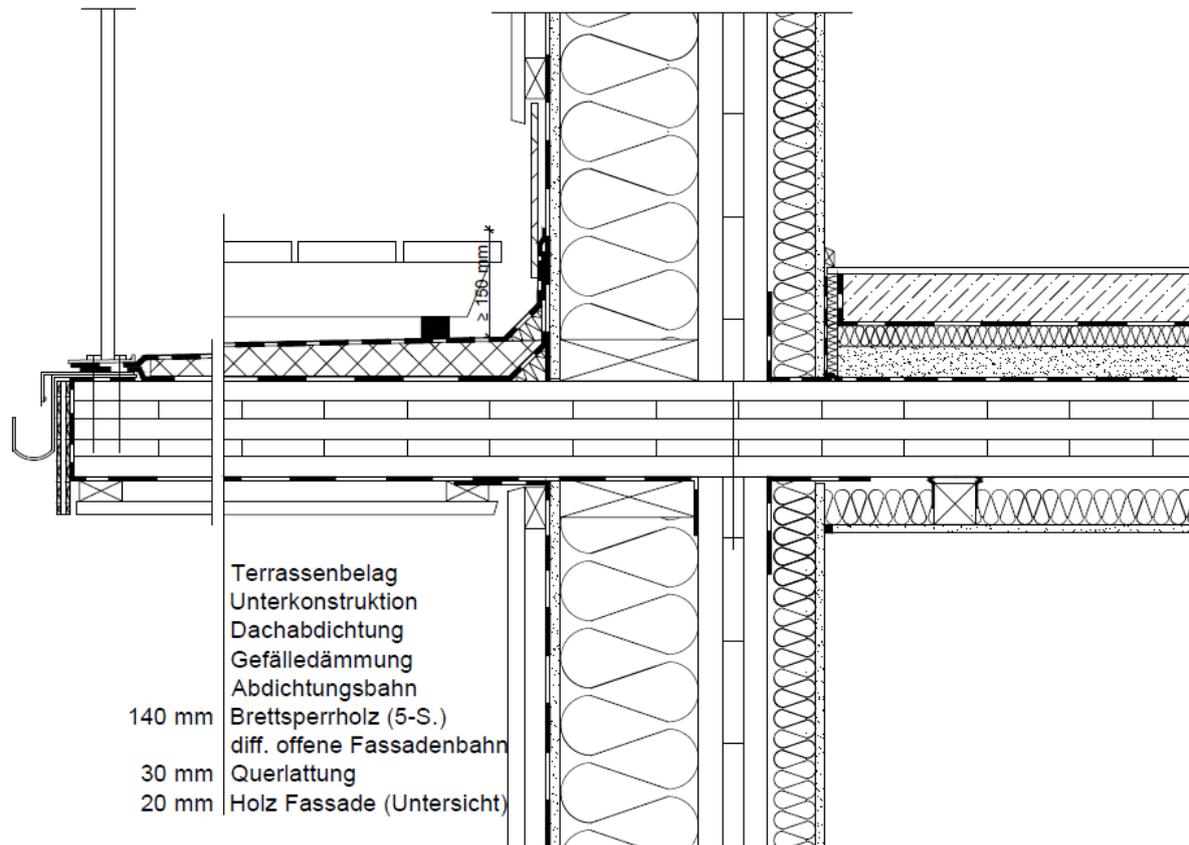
Anschlussdetail Auskragende BSP Deckenplatte (gdmnxa01a) – Außenwand (Holzmassivbauweise)
